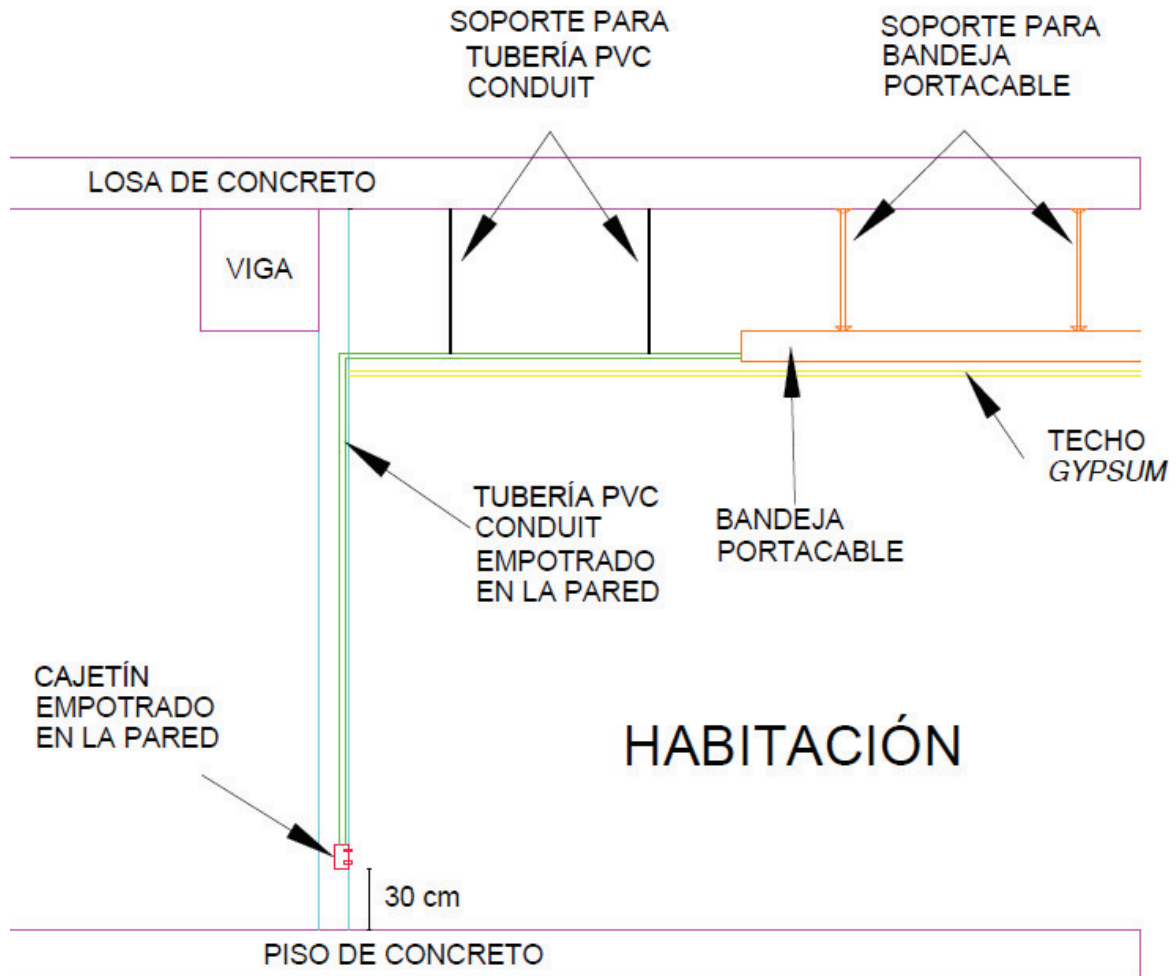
Detalle de tubería en el subsistema de cableado horizontal para voz y datos.
